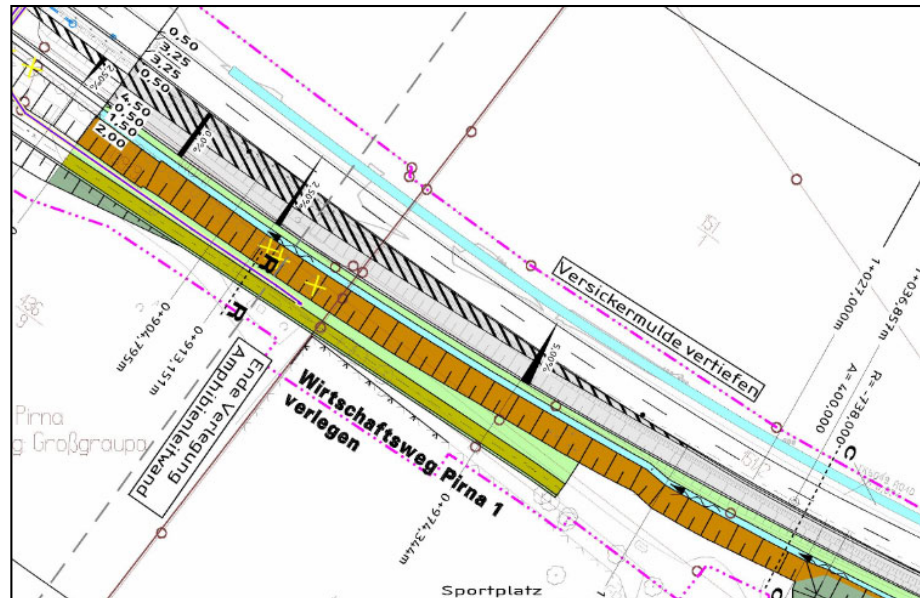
Lageplanarstellung der Fahrstreifensubtraktion ab Bau-km 0+803 (LASUV SACHSEN)
